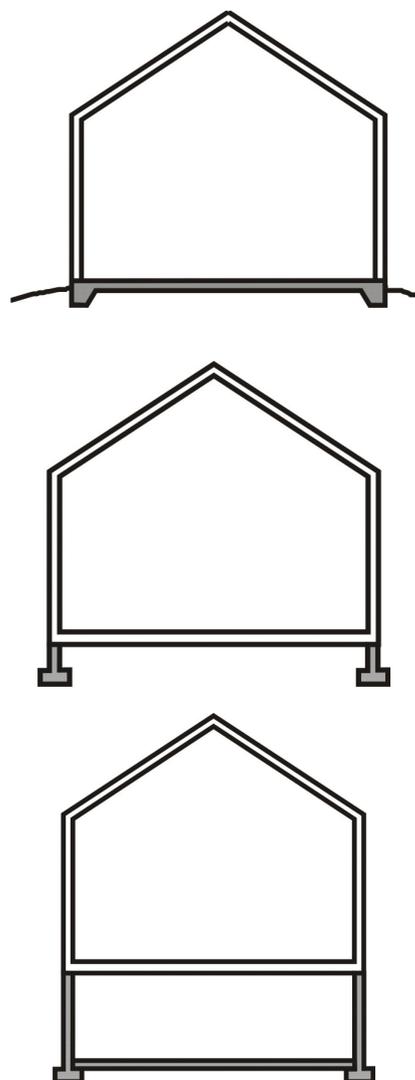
Os três tipos de fundações mais comuns, (de cima para baixo): Sobre laje de cimento; suspensa; porão.
